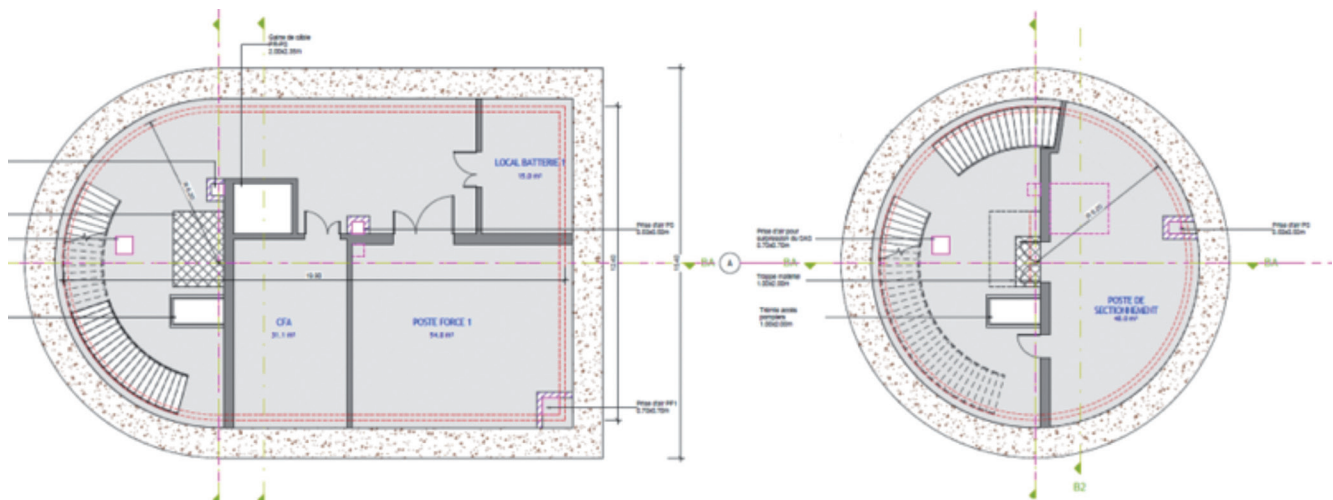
Vues en plan de plusieurs niveaux d'un puits type 3
